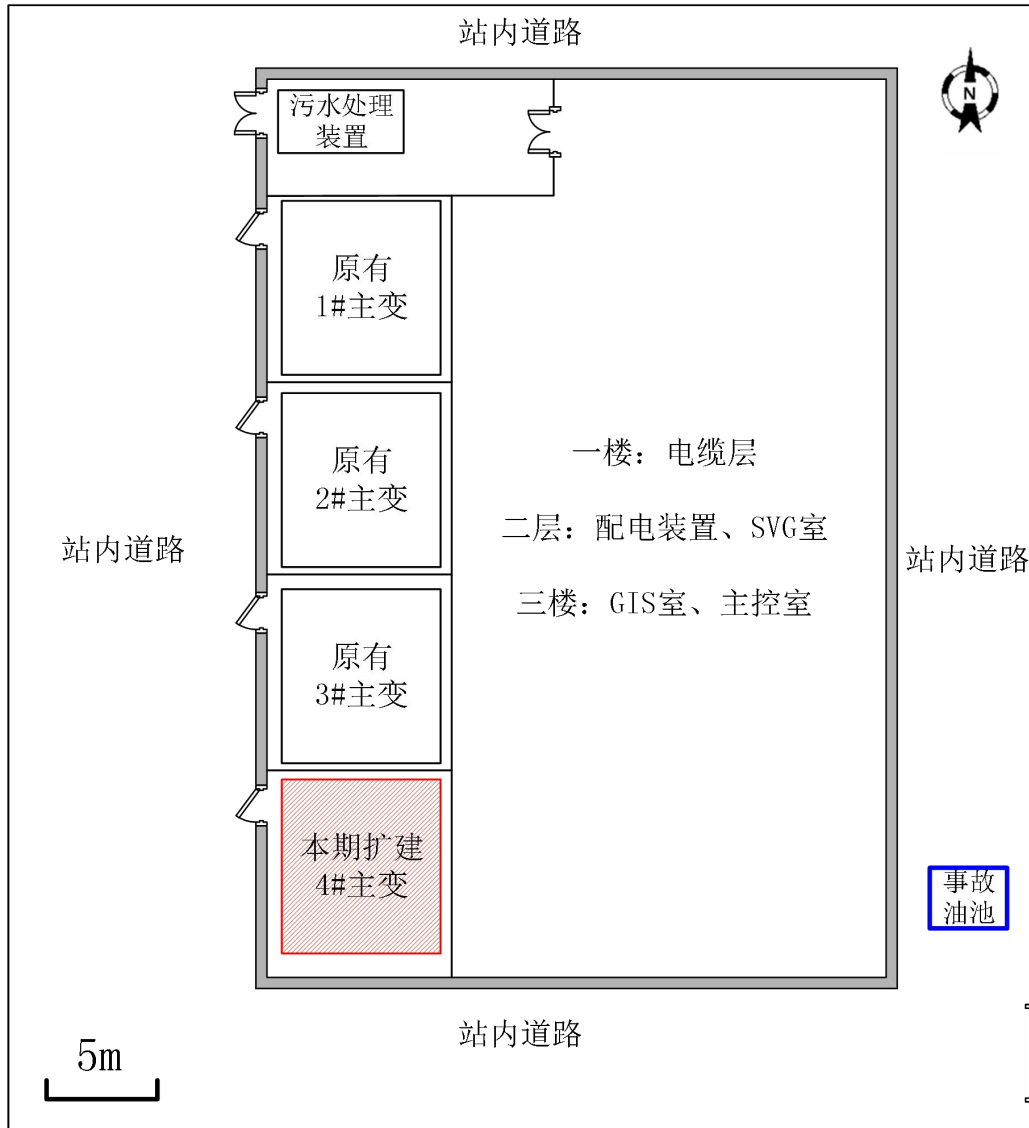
联峰 110kV 9# 变电所平面布置示意图
